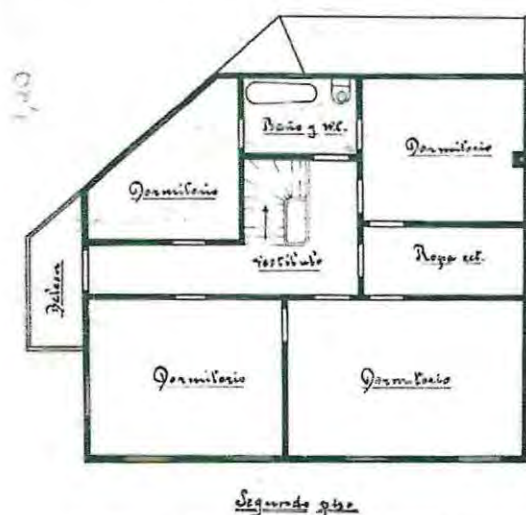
Waisberg, M. (1988). Casa Artillería 156
